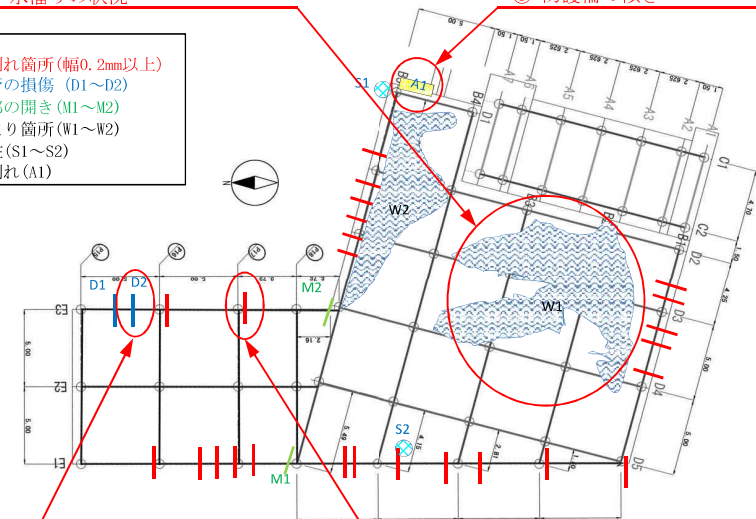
搬出入施設・車両乗降部 平面図 (上部工)
